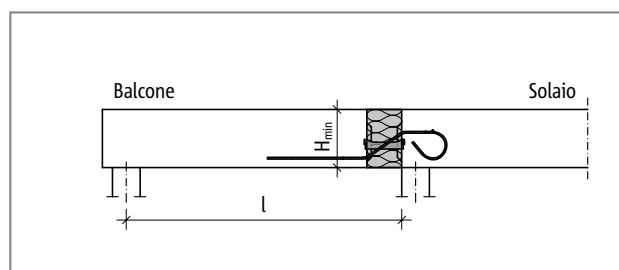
Schöck Isokorb® tipo QXT: schema statico (tipo QXT10 – QXT40)
